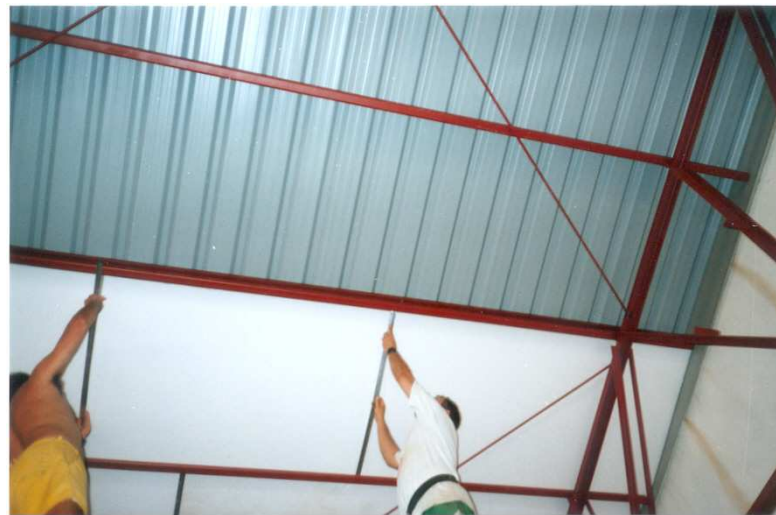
Colocación de los perfiles en forma de T invertida para mayor solidaridad entre las planchas de EPS.
